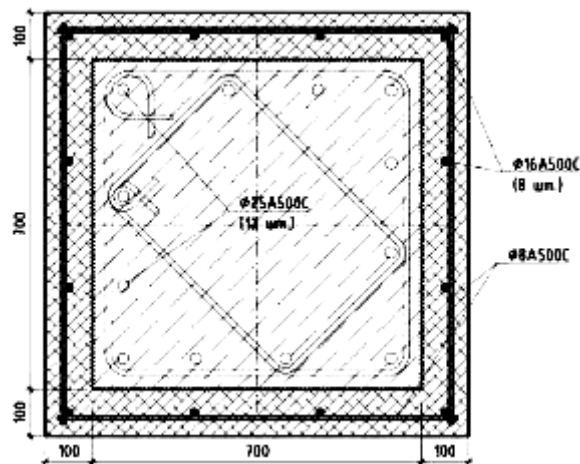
Схема усиления железобетонной колонны каркаса подземной части здания с применением сталефиброжелезобетонной обоймы
